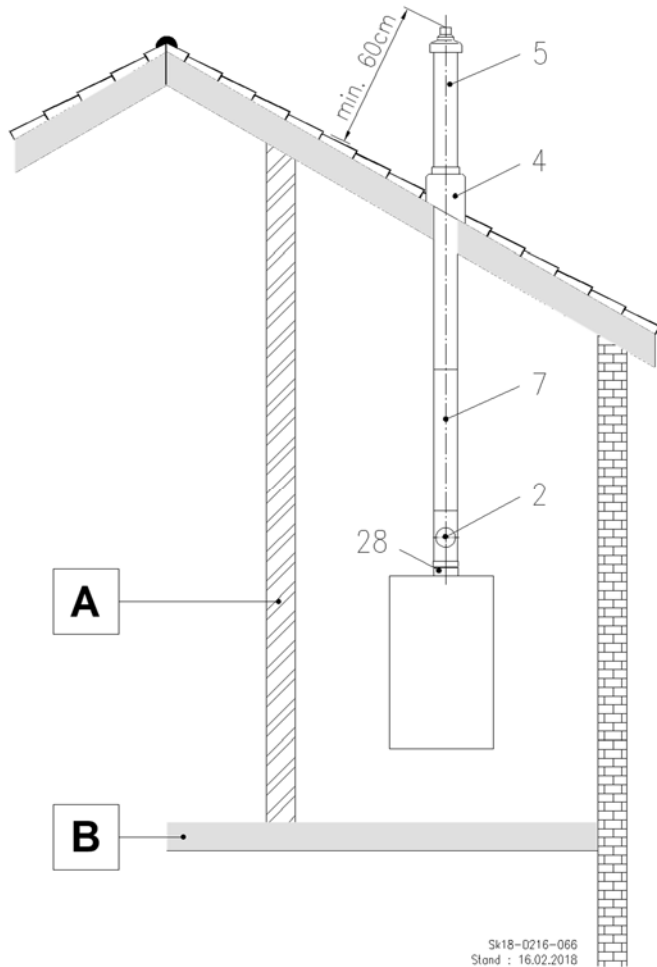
C_{33x} Dachheizzentrale mit der Durchführung senkrecht durch ein Schrägdach
